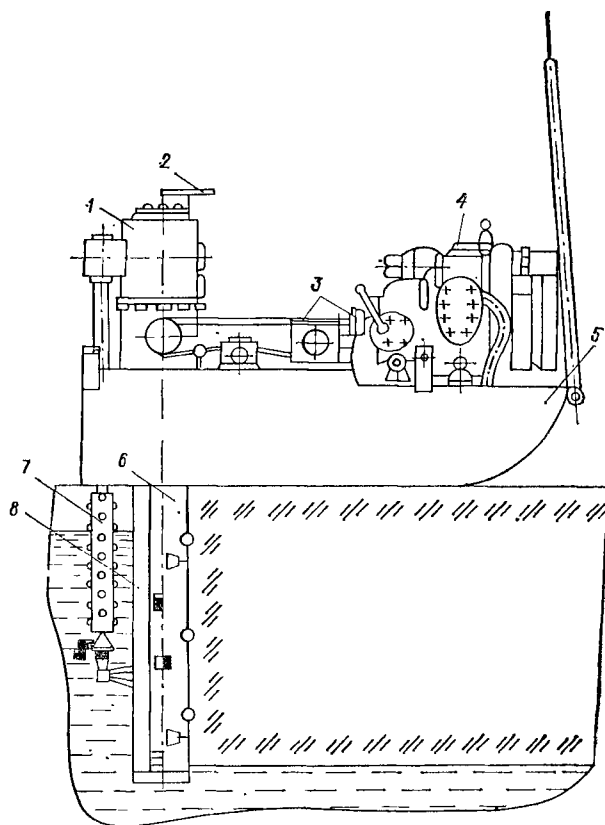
Малогабаритная самоходная ледорезная установка СЛУ-80 [109].
